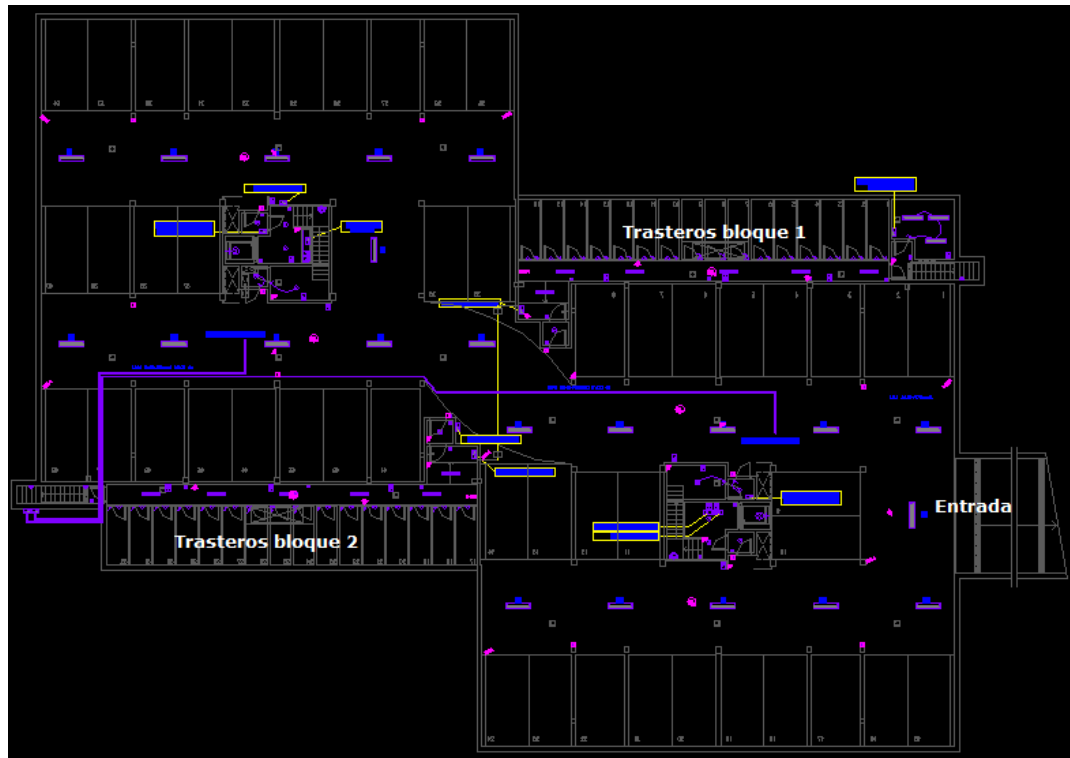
Detalle del plano de la planta sótano del edificio tipo
